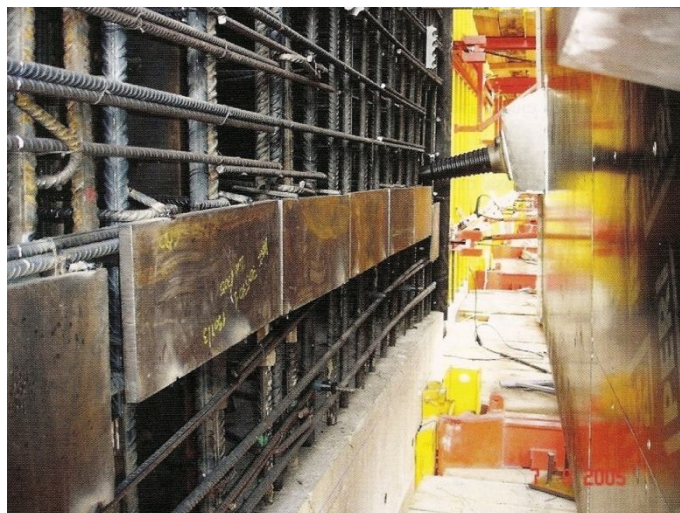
Placas metálicas fixadas à armadura antes de betonar (Sainz, 2006)
